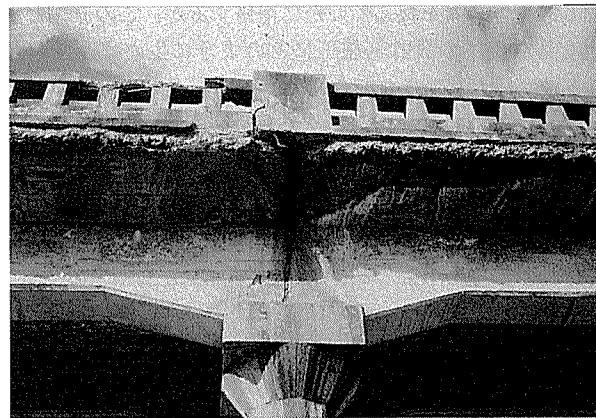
塩化物によるコンクリート表面の激しいスケーリング劣化(凍害)
